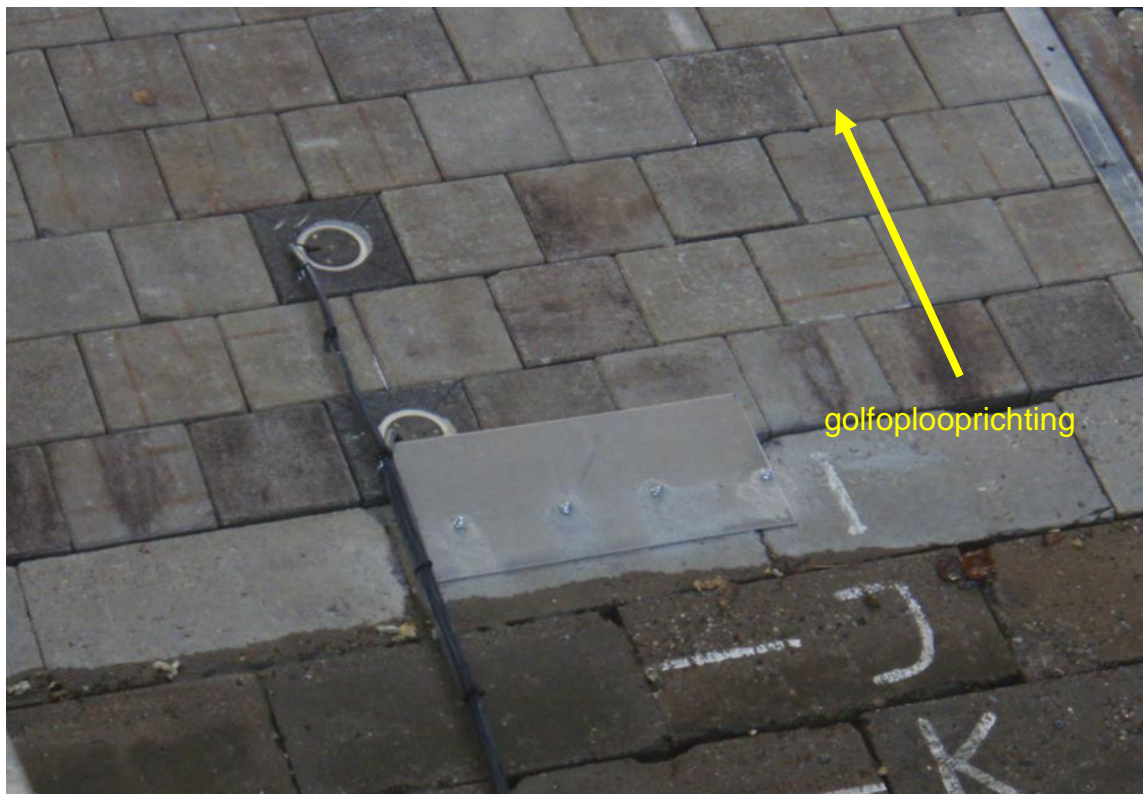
Metalen afdekstrip voor blok met DRO 5
